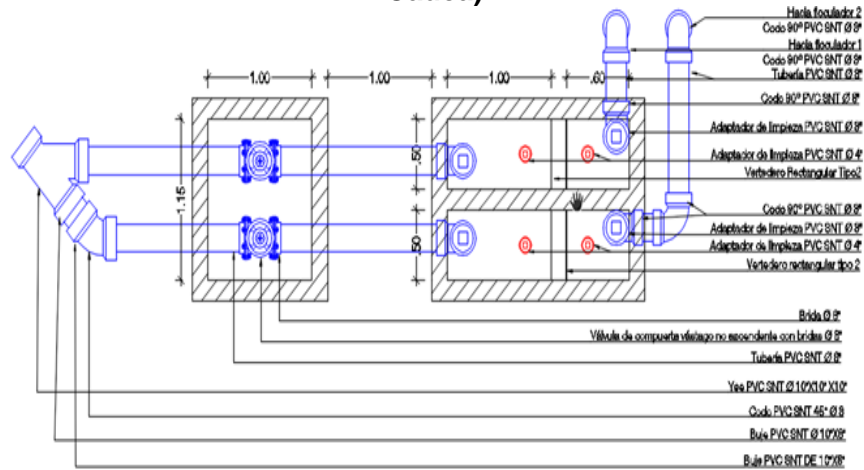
Vista en planta cámaras de distribución de caudal PTAP de Olaya (Patía-Cauca).
